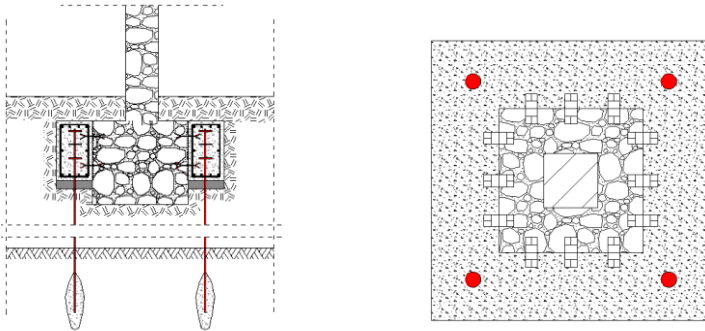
Refuerzo zapata aislada 4. 2010. Rehabilitar con Acero
